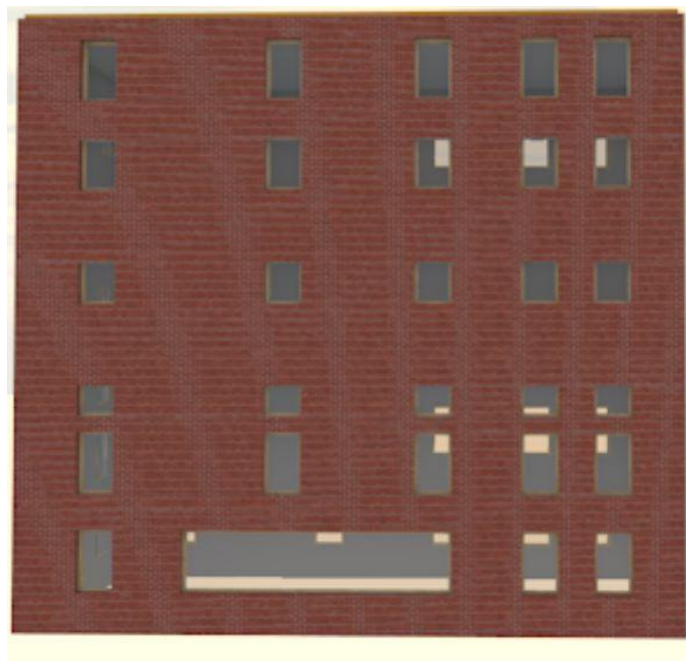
Vista lateral Izquierda de la edificación. Fuente: Nicolás Pozo
